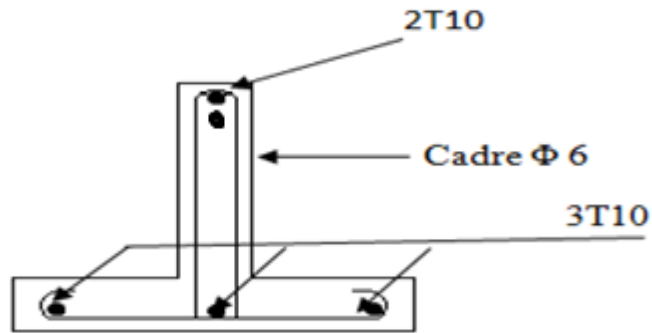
Disposition constructive des armatures des poutrelles du plancher terrasse
